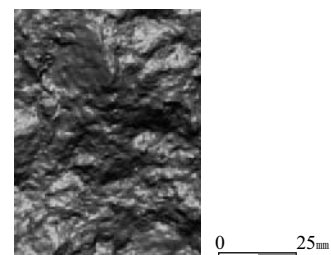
3次元デジタイザーで撮影されたひび割れ面
